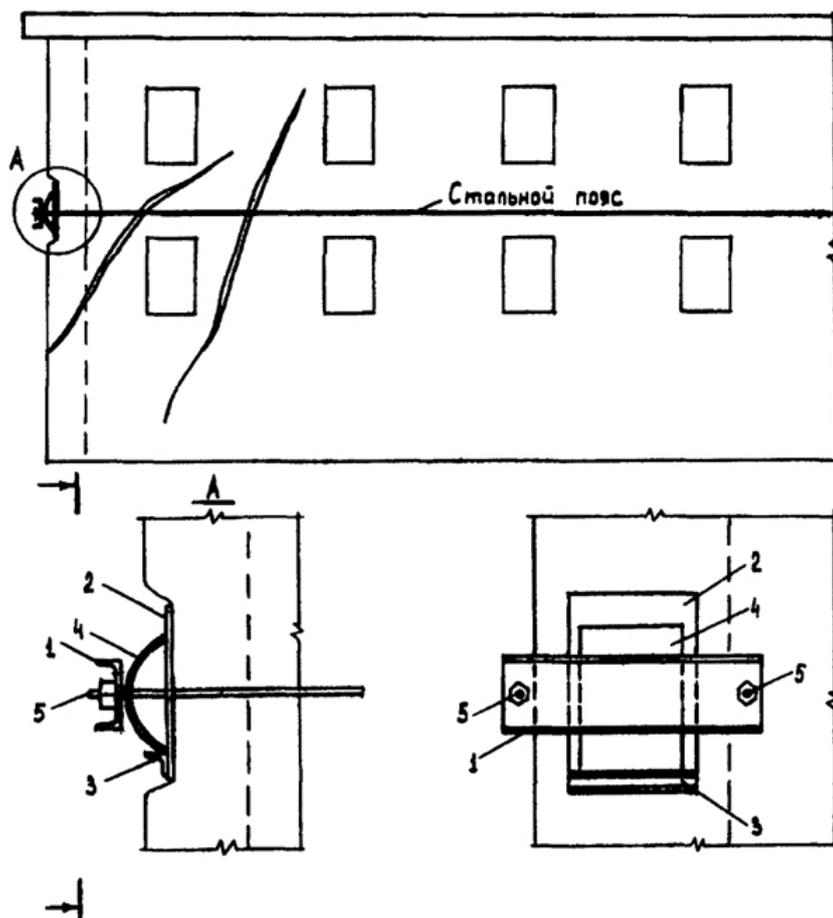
Усиление кирпичной стены поясом со стабилизирующим устройством: 1 - поперечная балка (швеллер); 2 - распределительная плита; 3 - упорный уголок; 4 - рессора; 5 - тяж (стержень)
